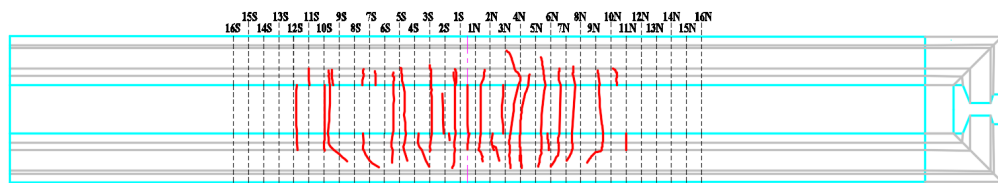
ひび割れ図（下面と側面の展開図、破線は100mm 間隔）
